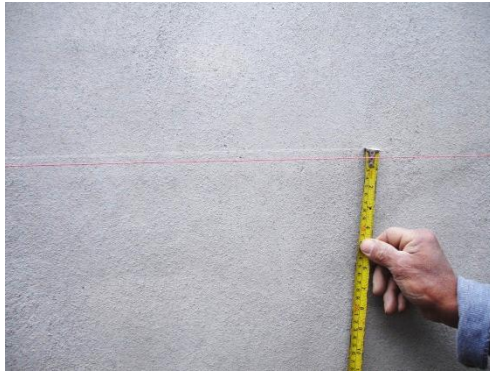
Deformación de 13mm. Mampostería tradicional.
